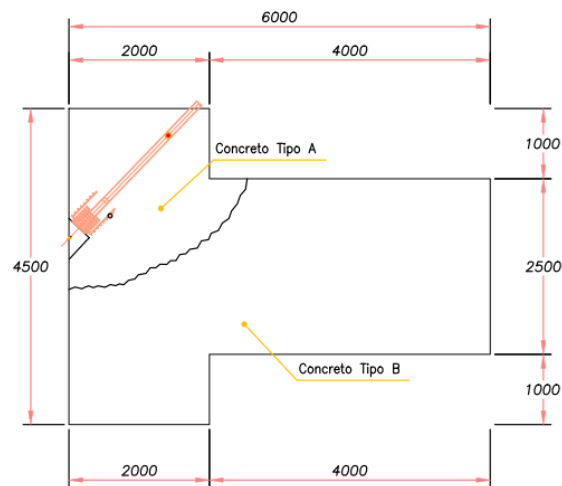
Vista en elevación de cámara de anclaje de retenida de Torre Pescante
